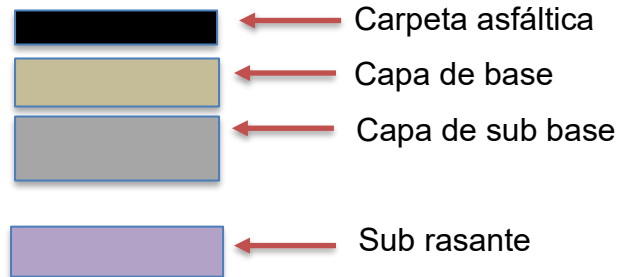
Elaboración propia (Estructura de Pavimento flexible)
